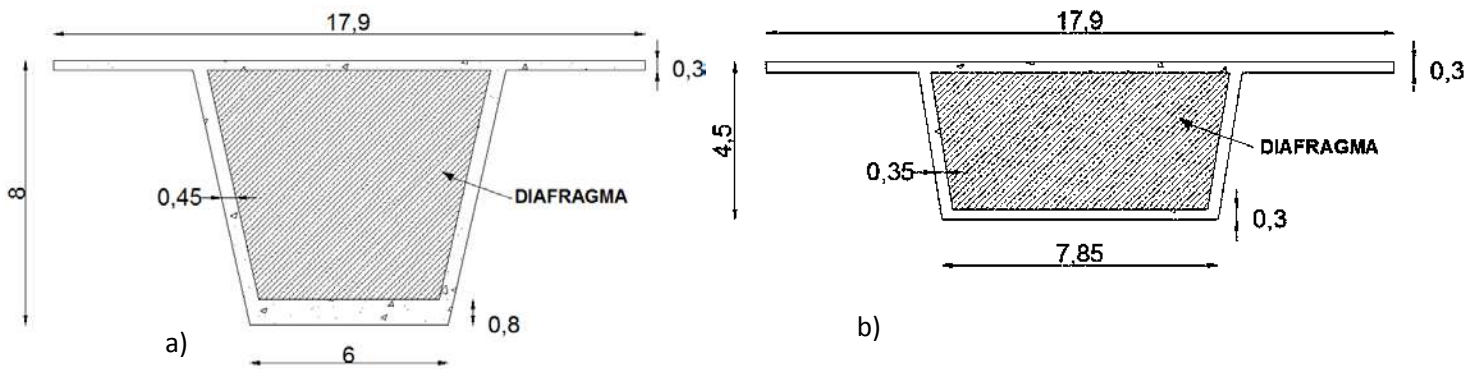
f Diafragmas a) Cerca de las pilas, b) En los extremos del puente. Cotas en metros.
